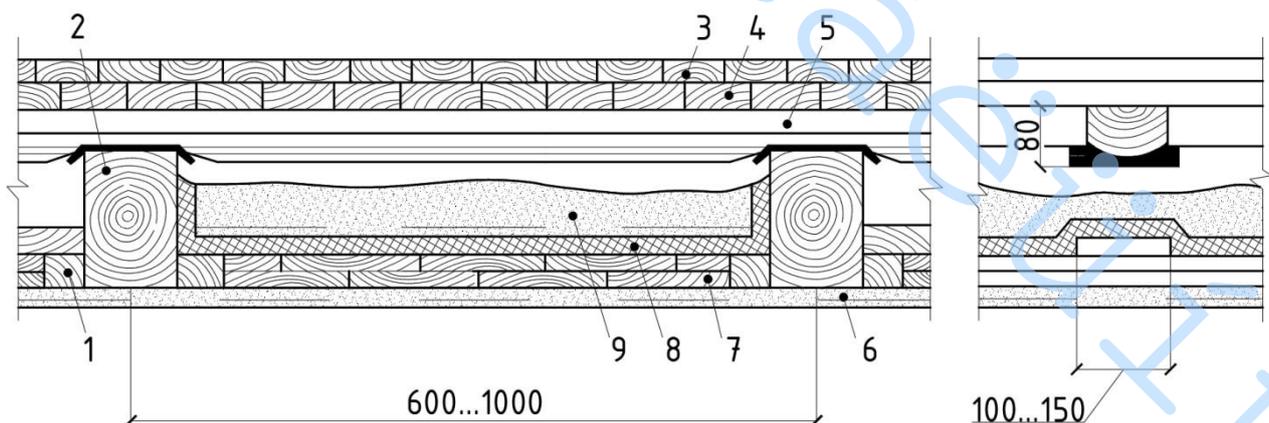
Конструкция деревянного междуэтажного перекрытия:
